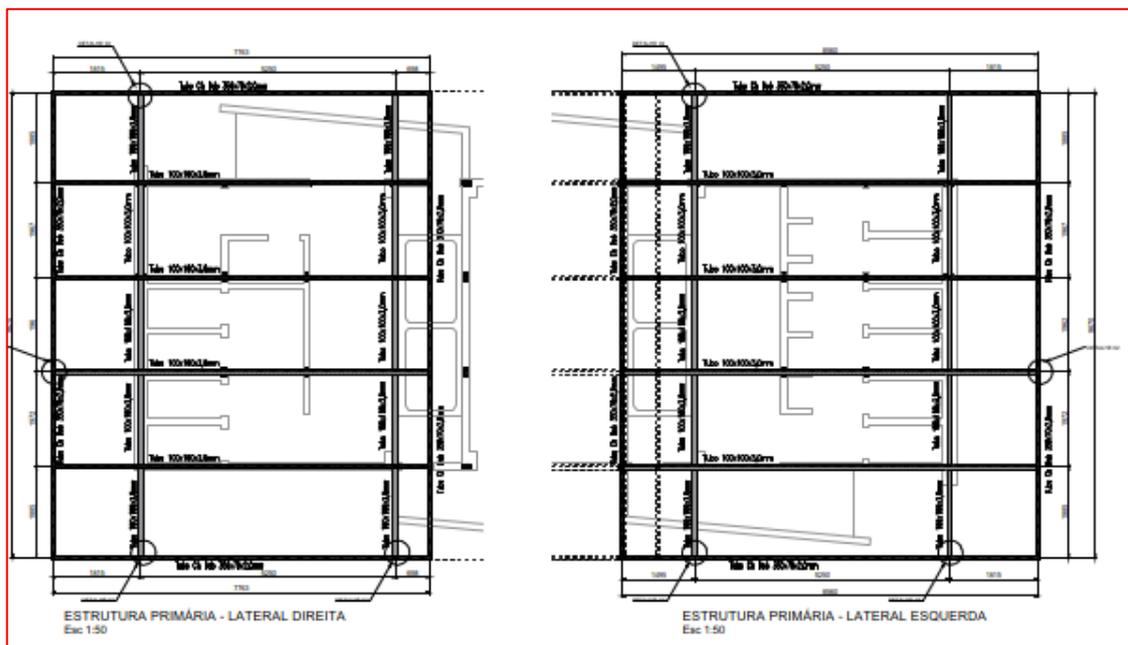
Projeto Estrutural da Cobertura - Fonte: CEASA/PR e FUNDAMENTO ENGENHARIA
